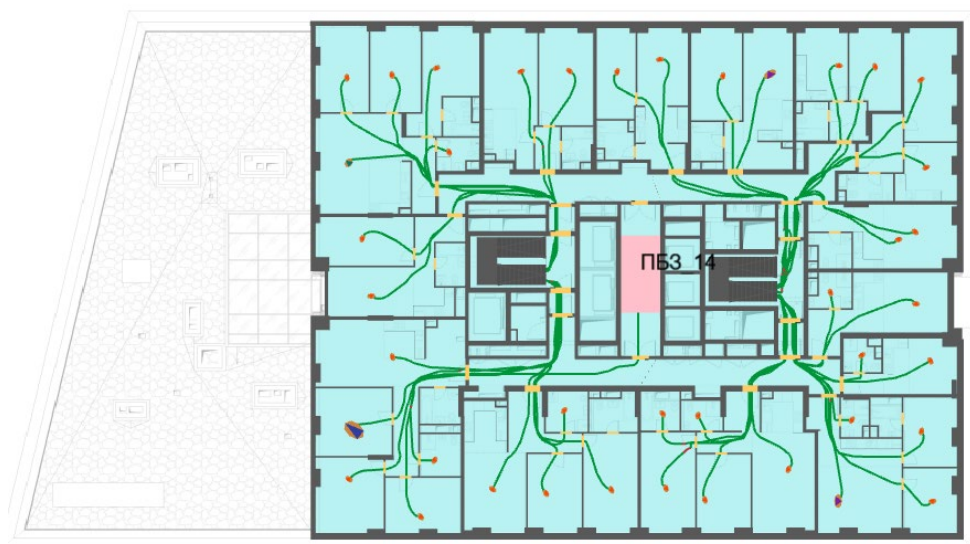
План 14-го этажа и нанесенная на него расчетная (принципиальная) схема эвакуации
